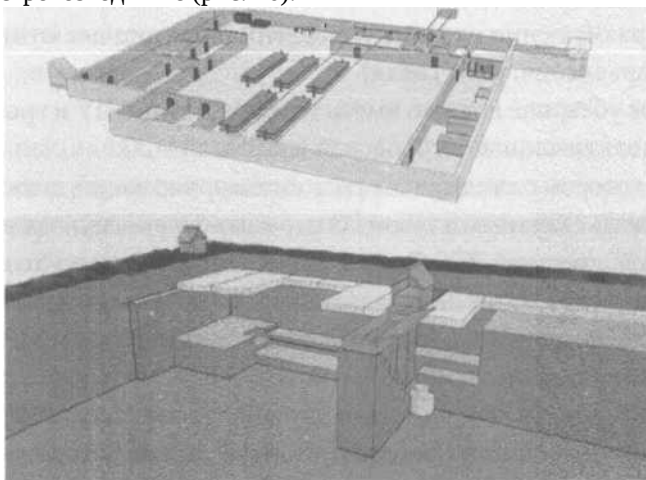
Заблаговременно возведенное убежище и быстровозводимое ПРУ из железобетонных плит
